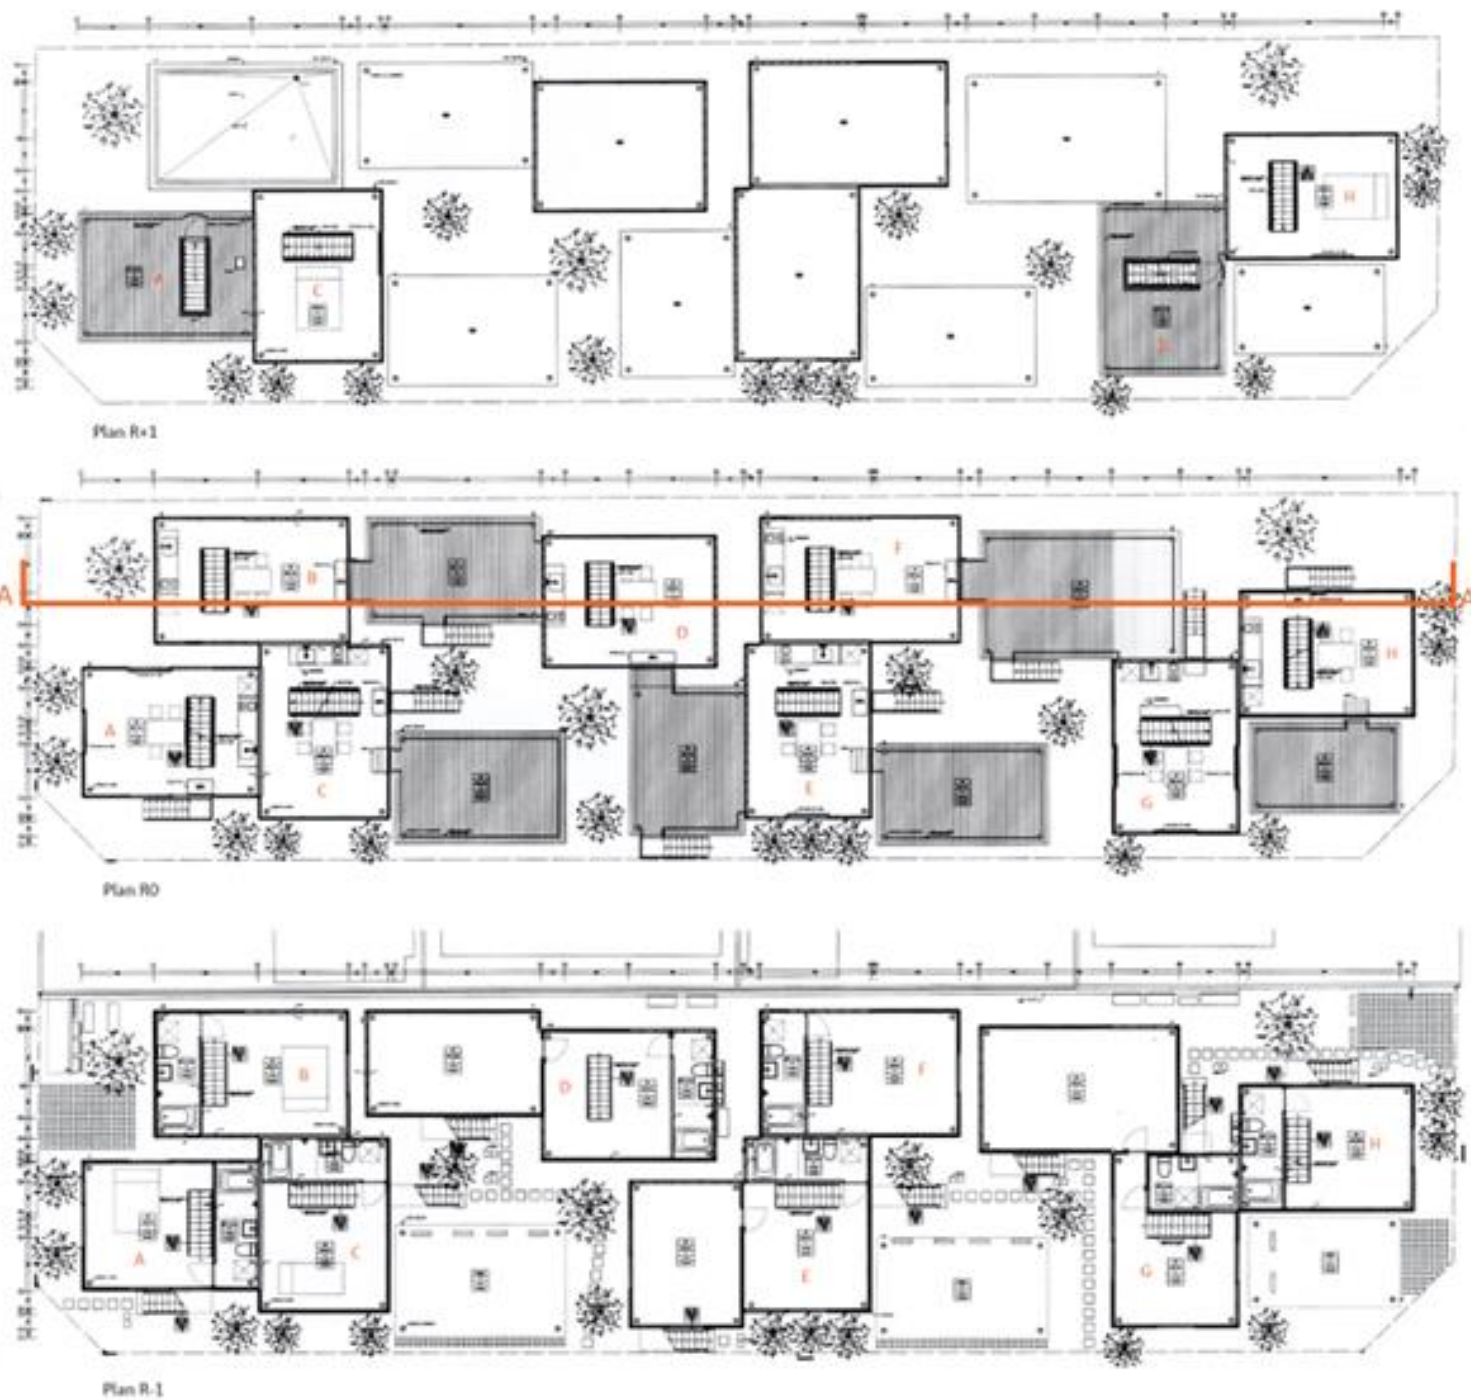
Plans R-1, R0 et R+1 du projet Shakujii Apartment
